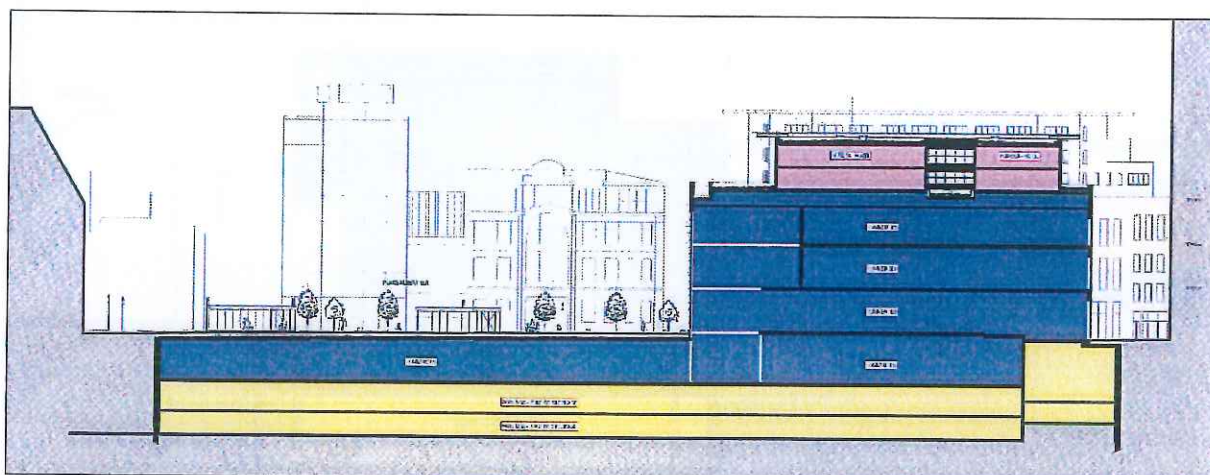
Coupe transversale (CC) au niveau de la place Albert 1^{er} (source : DDS & Partners)
